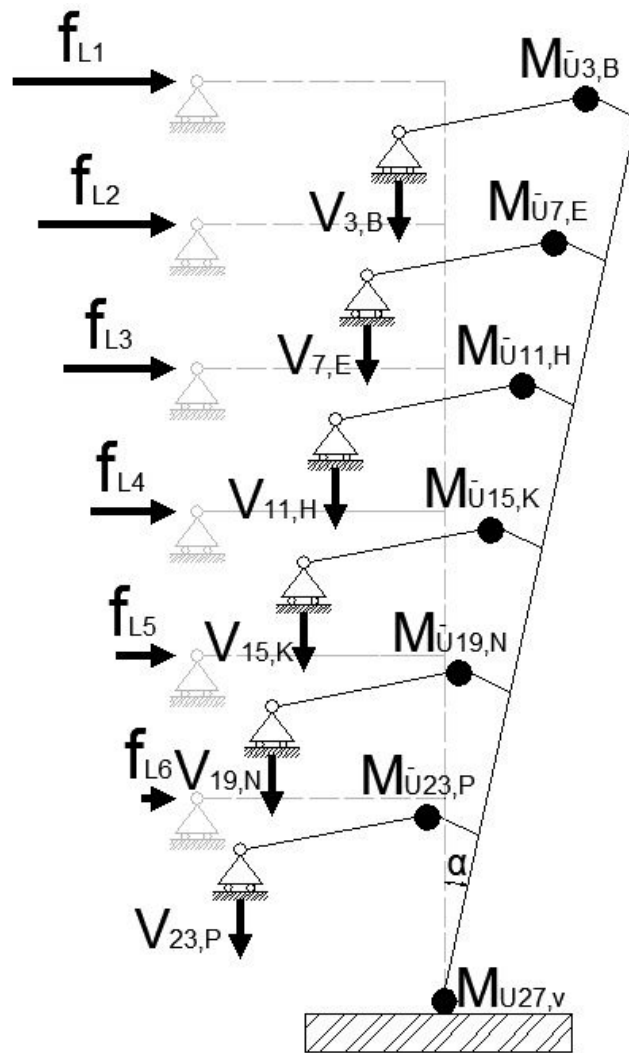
Análisis plástico de columna derecha del pórtico 1. Pilar 4
